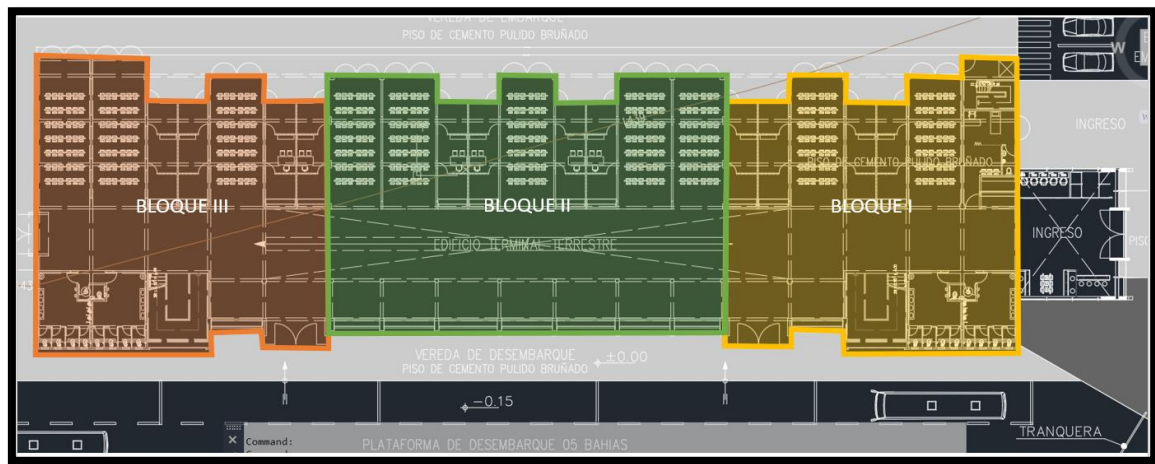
Se aprecia los bloques donde se divide la edificación del terminal terrestre (fuente expediente técnico)
